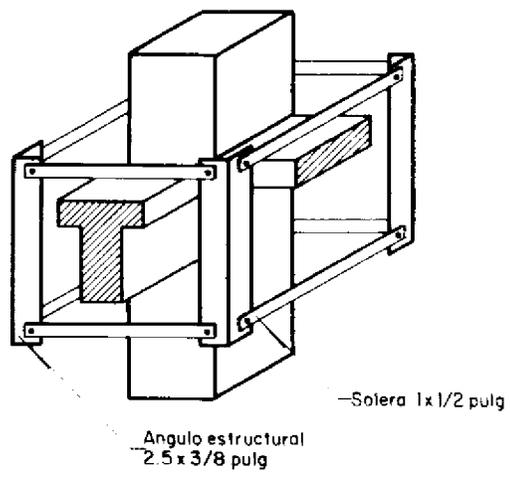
Jaula de confinamiento de la junta (tomado de la ref 14)
